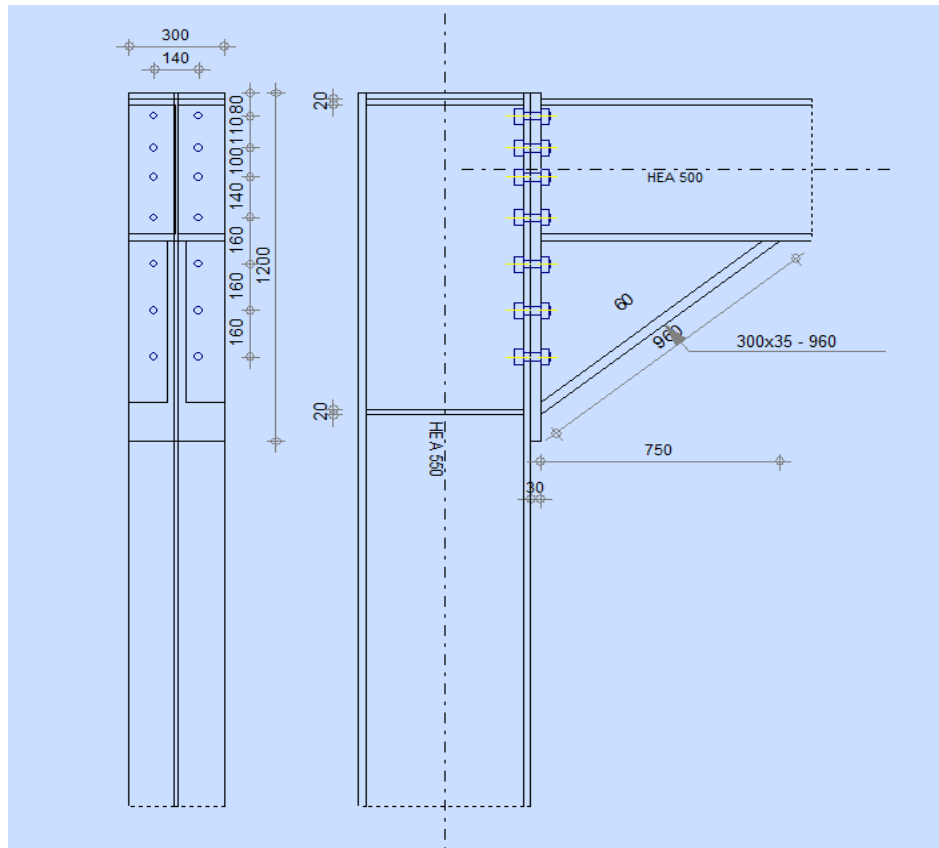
Détail d’assemblage poteau - poutre principale.
